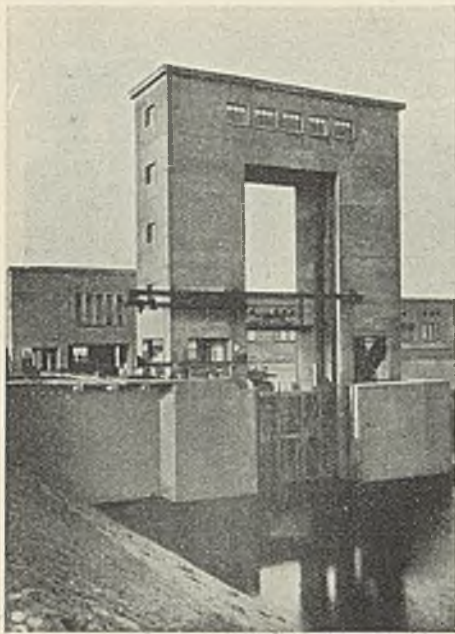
Oberhaupt mit Tor und Dammbalkenversetzkran.
